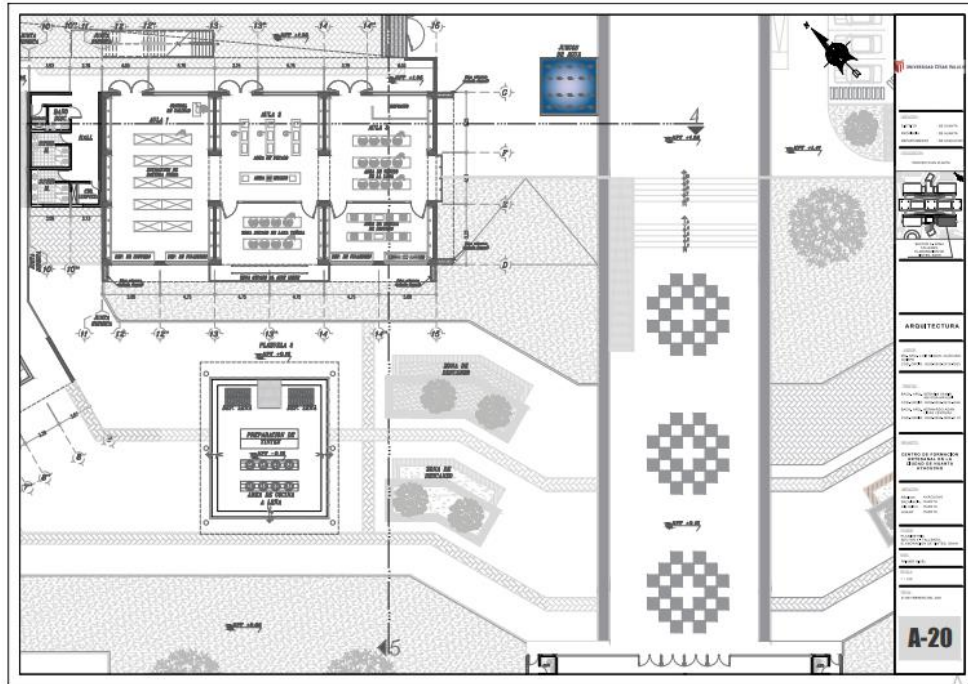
Planimetría del sector 5 ubicado en el piso 1. Escala 1/100.
